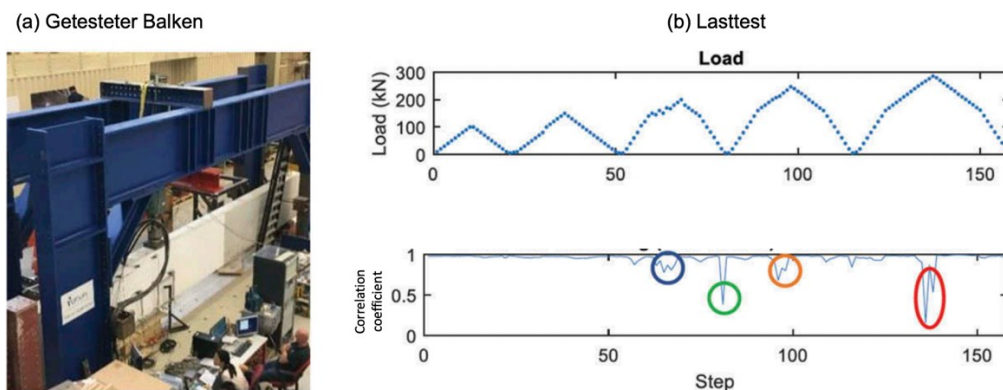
Pilotstudie an einem massstabgetreuen Betonbalken (a) unter zyklischer Last (b). Deutliche Verringerungen des Wertes des Korrelationskoeffizienten (c) deuten auf Rissbildung hin. Beobachtete Rissentstehungen sind farblich eingekreist. Angepasst von [479]
